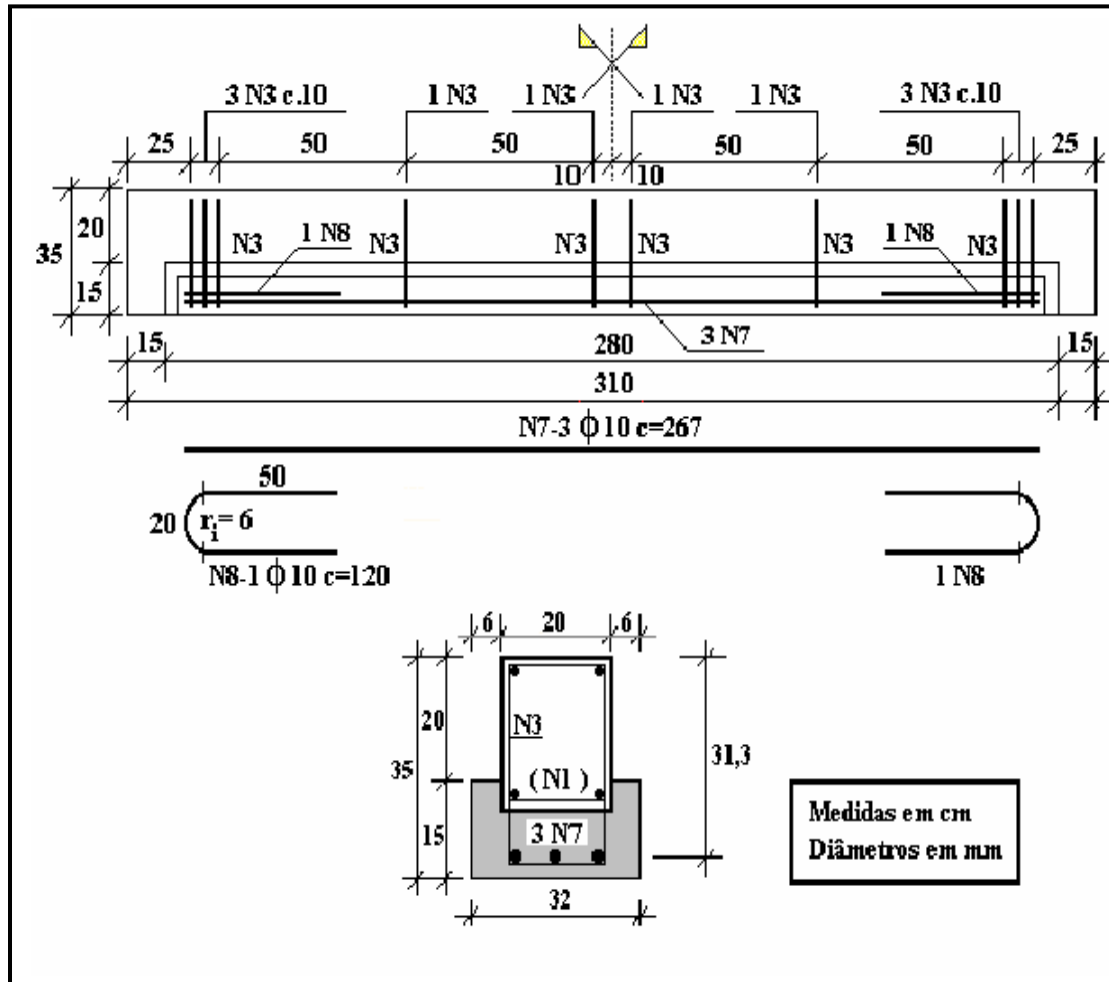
Detalhamento das Vigas reforçadas e das vigas monolíticas de referência da série 4 (PIANCASTTELI e CALIXTO, 2002).
